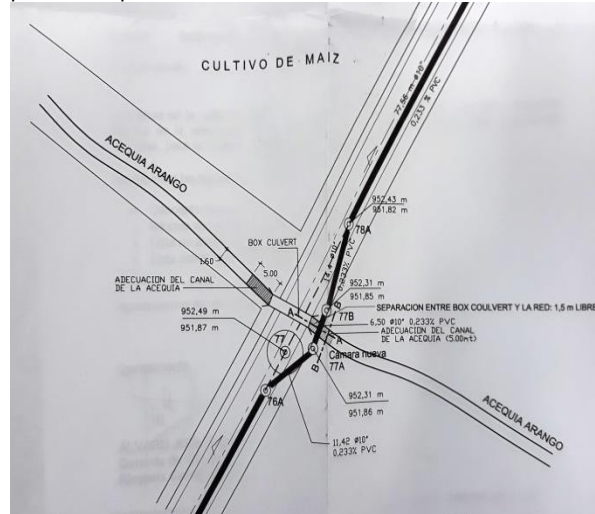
Localización general de las obras proyectadas para el cruce aéreo del alcantarillado de Palomestizo sobre la acequia Arengo.
